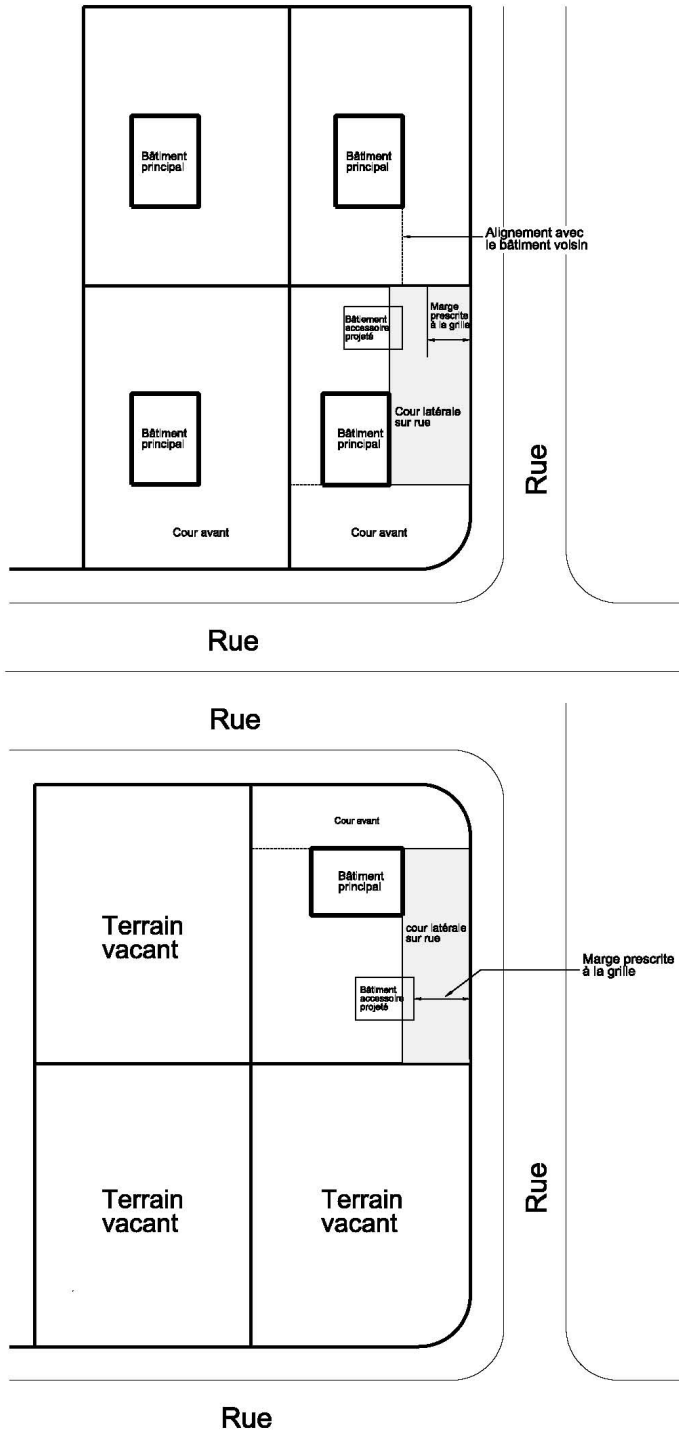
Bâtiment accessoire en cour arrière sur rue
